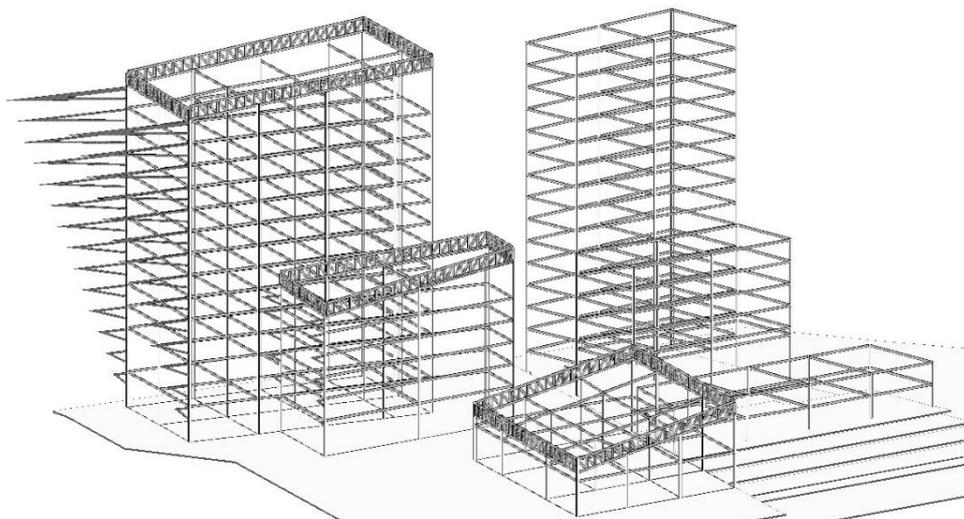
3D de la structure du projet architecturale. /source : par l'auteur.
